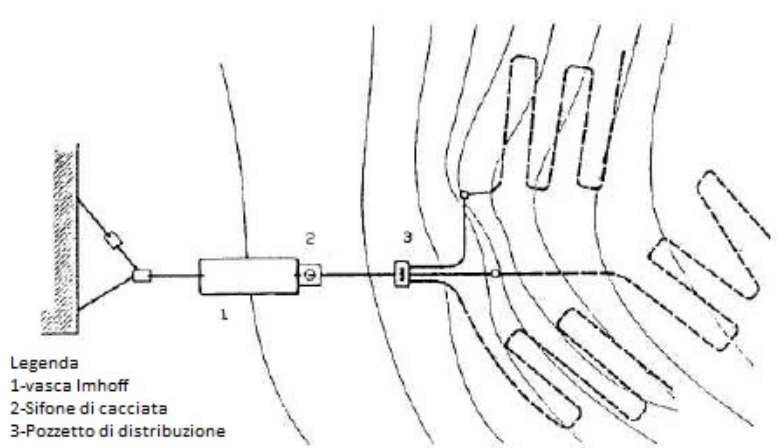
Andamento planimetrico delle condotte di subirrigazione
